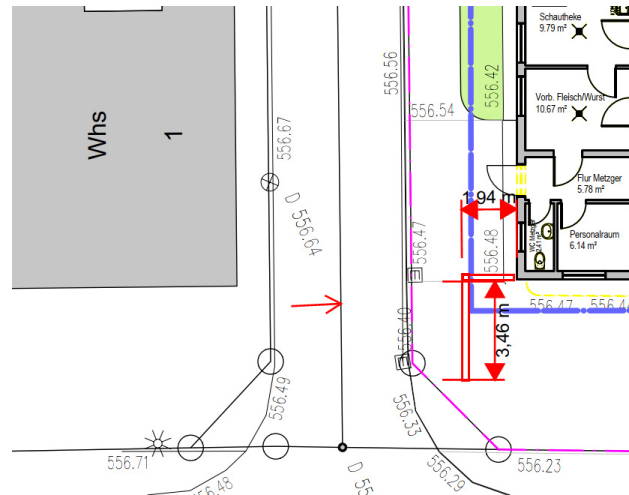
Ausschnitt aus dem Lageplan, zusätzliche Abschirmung nach Süden
